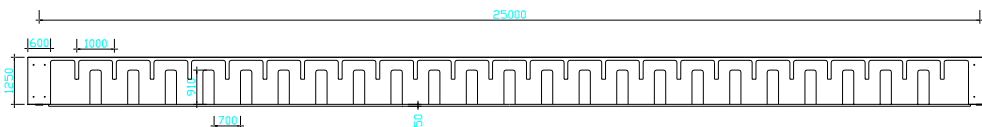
Coupe longitudinale - solution 25 m - Dalle BFUP gaufree-échancrée et matériau composite
